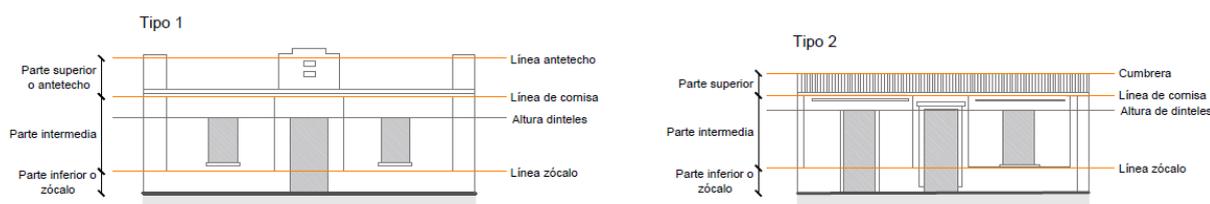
Esquemas de composición de la fachada de construcciones de la población San José, tipo 1 y 2.
